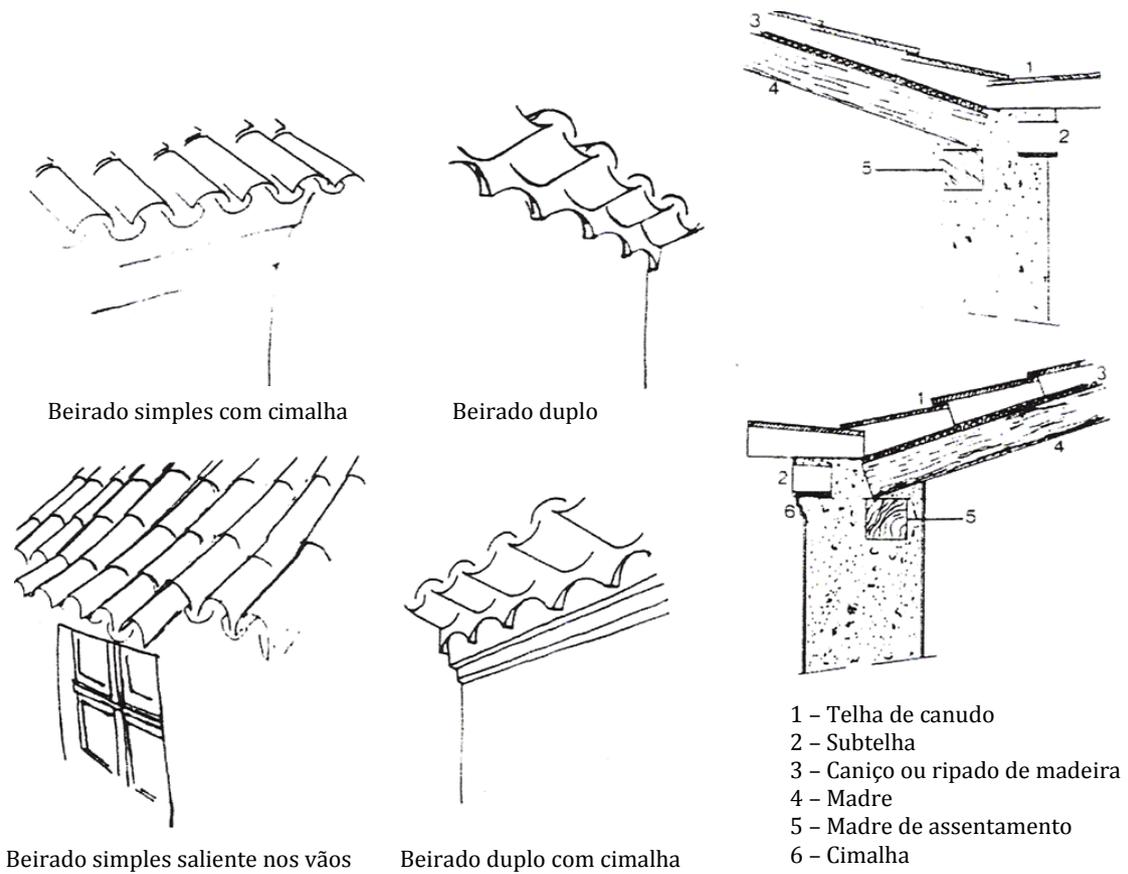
Exemplo de vários tipos de beirado tradicional e exemplo de telhado com subtelha <sup>[11]</sup>
